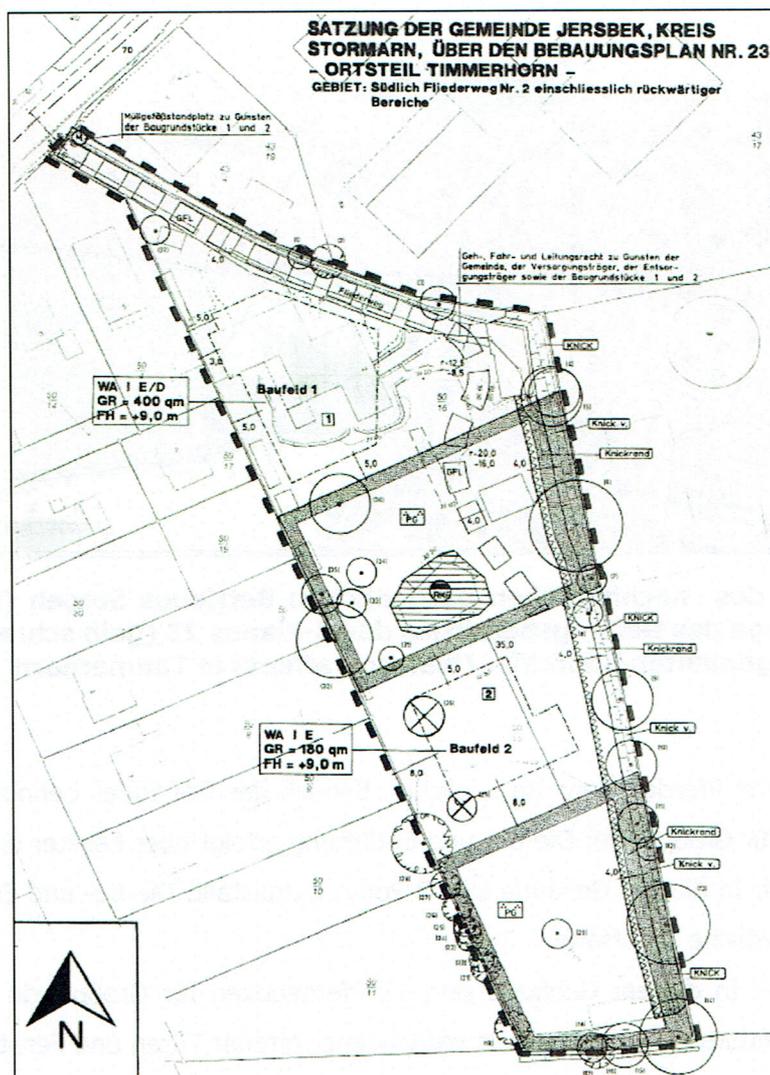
Lage des B-Planes Nr. 23 - Jersbek – Ortsteil Timmerhorn (Quelle: verändert nach dem Lageplan ML-Planung, Lübeck, 2018)
